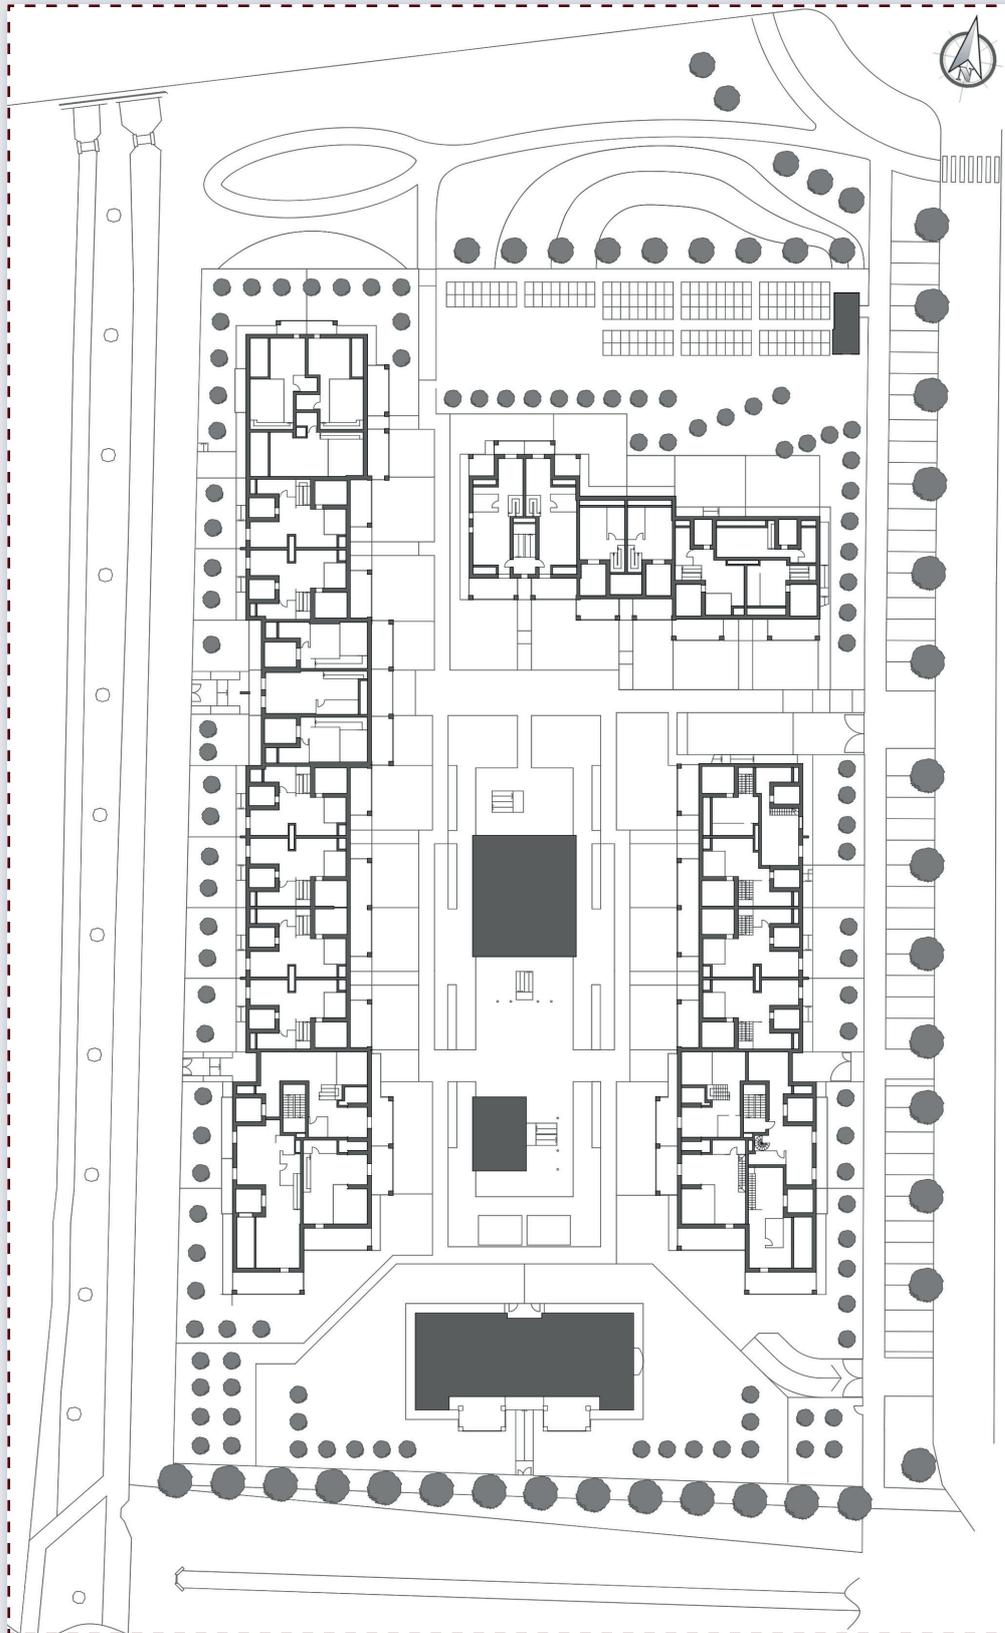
Planimetria generale del complesso residenziale - piano terra
